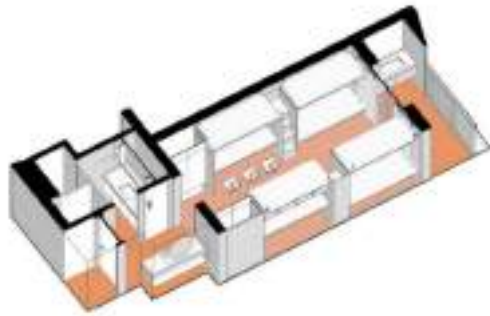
Ruang Komunal pada Balkon Student Dormitory of Hangzhou
